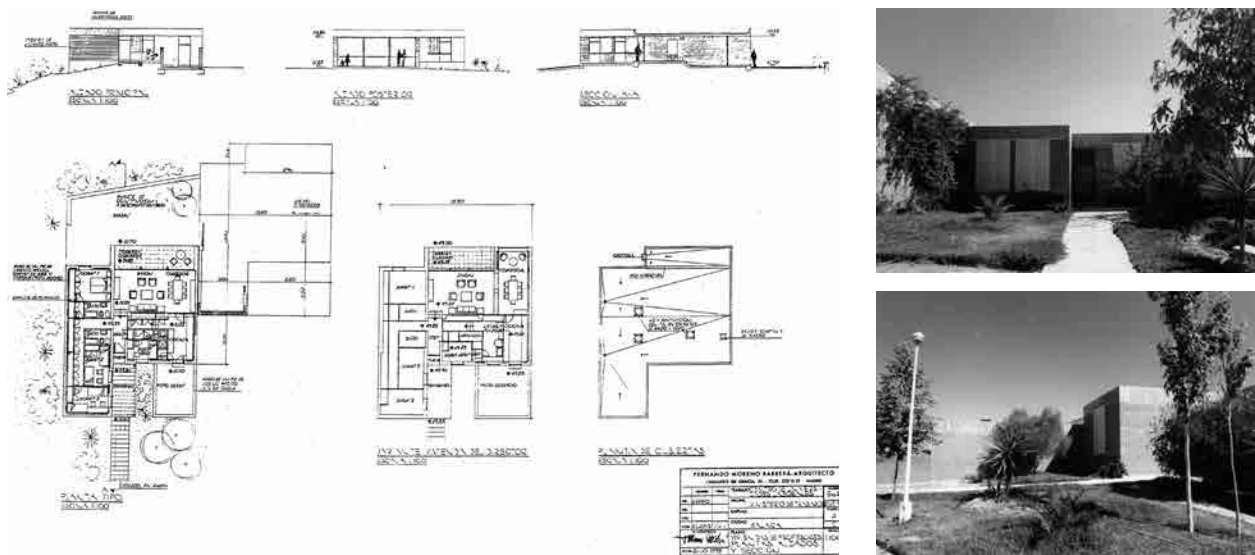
, Fig. 59, Fig. 60, Fig. 61, Fig. 62 y Fig. 63 Planimetría de las viviendas (izquierda). Fila superior: alzado principal (izquierda), alzado posterior (centro) y sección longitudinal (derecha). Fila inferior: planta tipo (izquierda), planta variante de la vivienda del director (centro, construida posteriormente según un proyecto distinto) y planta de cubiertas (derecha). Fig. 64 y Fig. 65 Viviendas. Vista de la fachada principal (arriba derecha) y vista en escorzo (abajo derecha). Fotografías de época.
